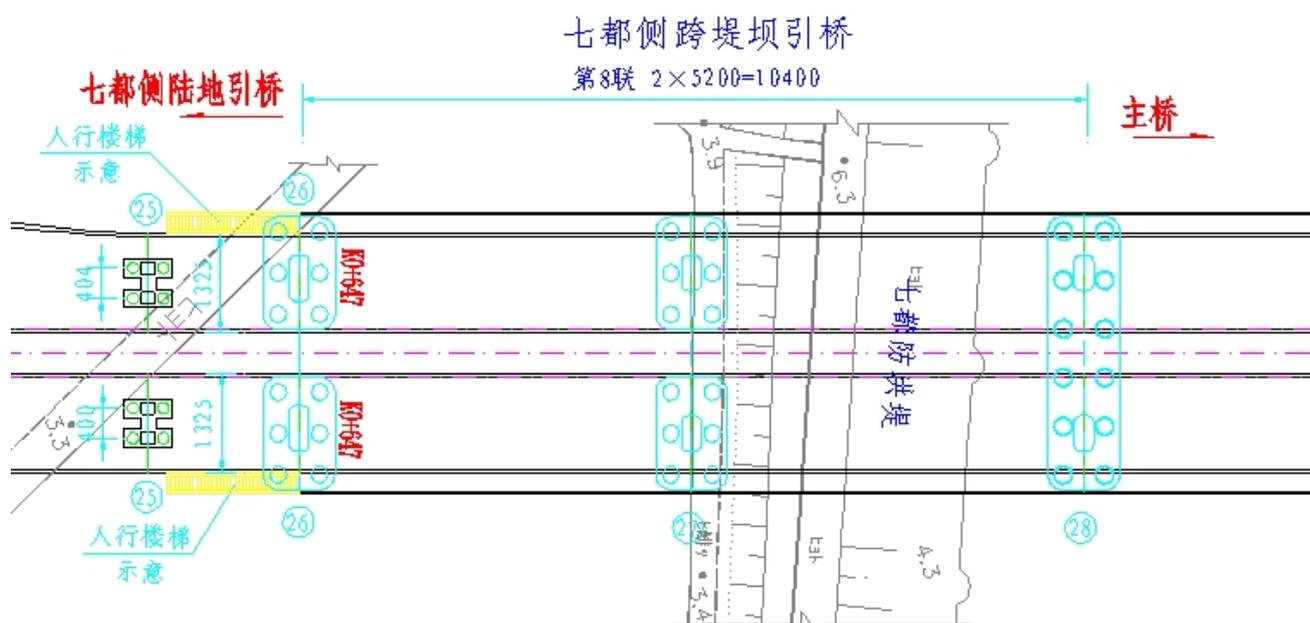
七都侧跨堤坝引桥桥跨布置平面图
